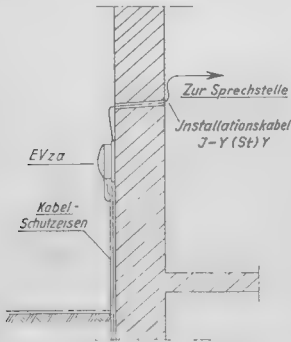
Einführen von unterirdischen Anschlußleitungen.
